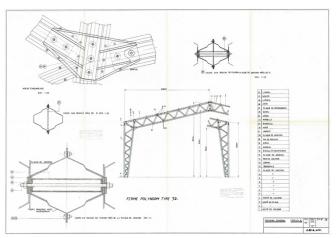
POLYNORM Zürich, Detailplan Fachwerkträger Typ-72, 1957. (Archives Ville de Fribourg).
